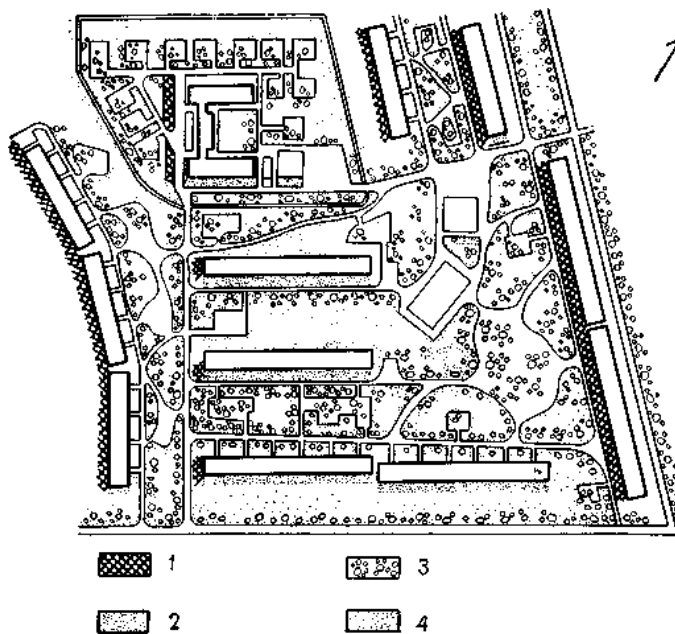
Схема розміщення зелених насаджень з урахуванням поліпшення мікроклімату: 1 — посадки, що захищають територію від теплової дії фасадів і приміщення від перегріву; 2 — посадки, що знижують теплову дію фасадів на прилеглу територію; 3 — посадки для захисту доріжок і майданчиків від інсоляції; 4 — посадки для захисту ґрунту від інсоляції.
